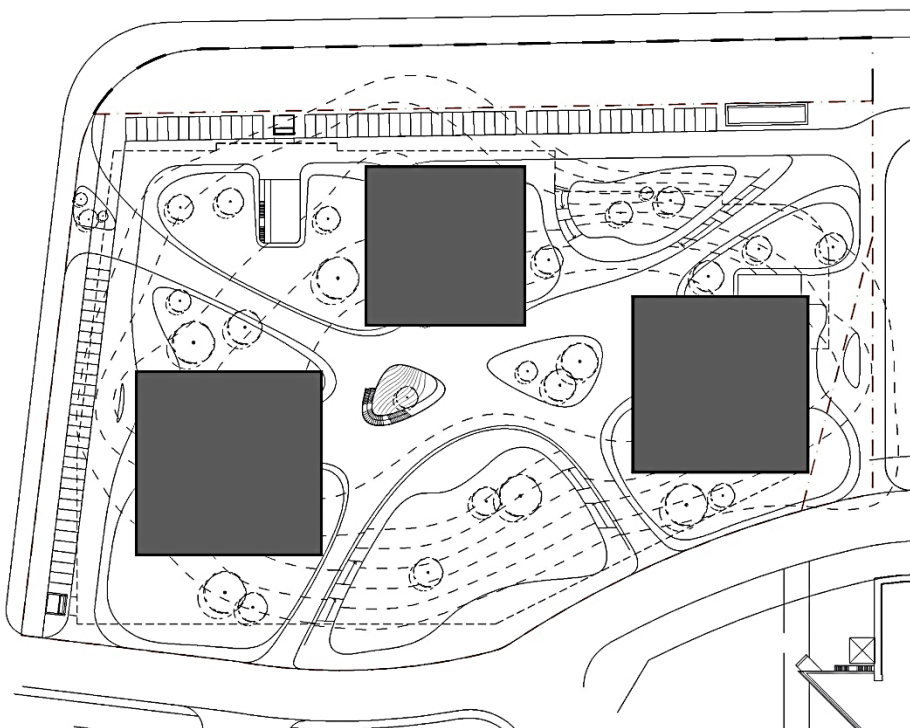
ГенПлан Бізнес-центру 3 Cubes
